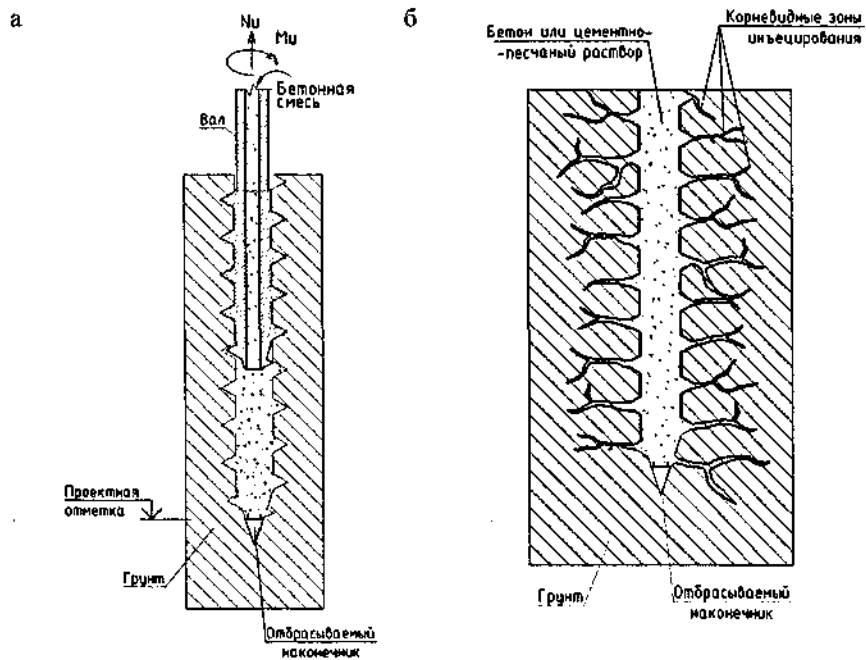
Монолитный вид свай АКСИС: а – изготовление;
